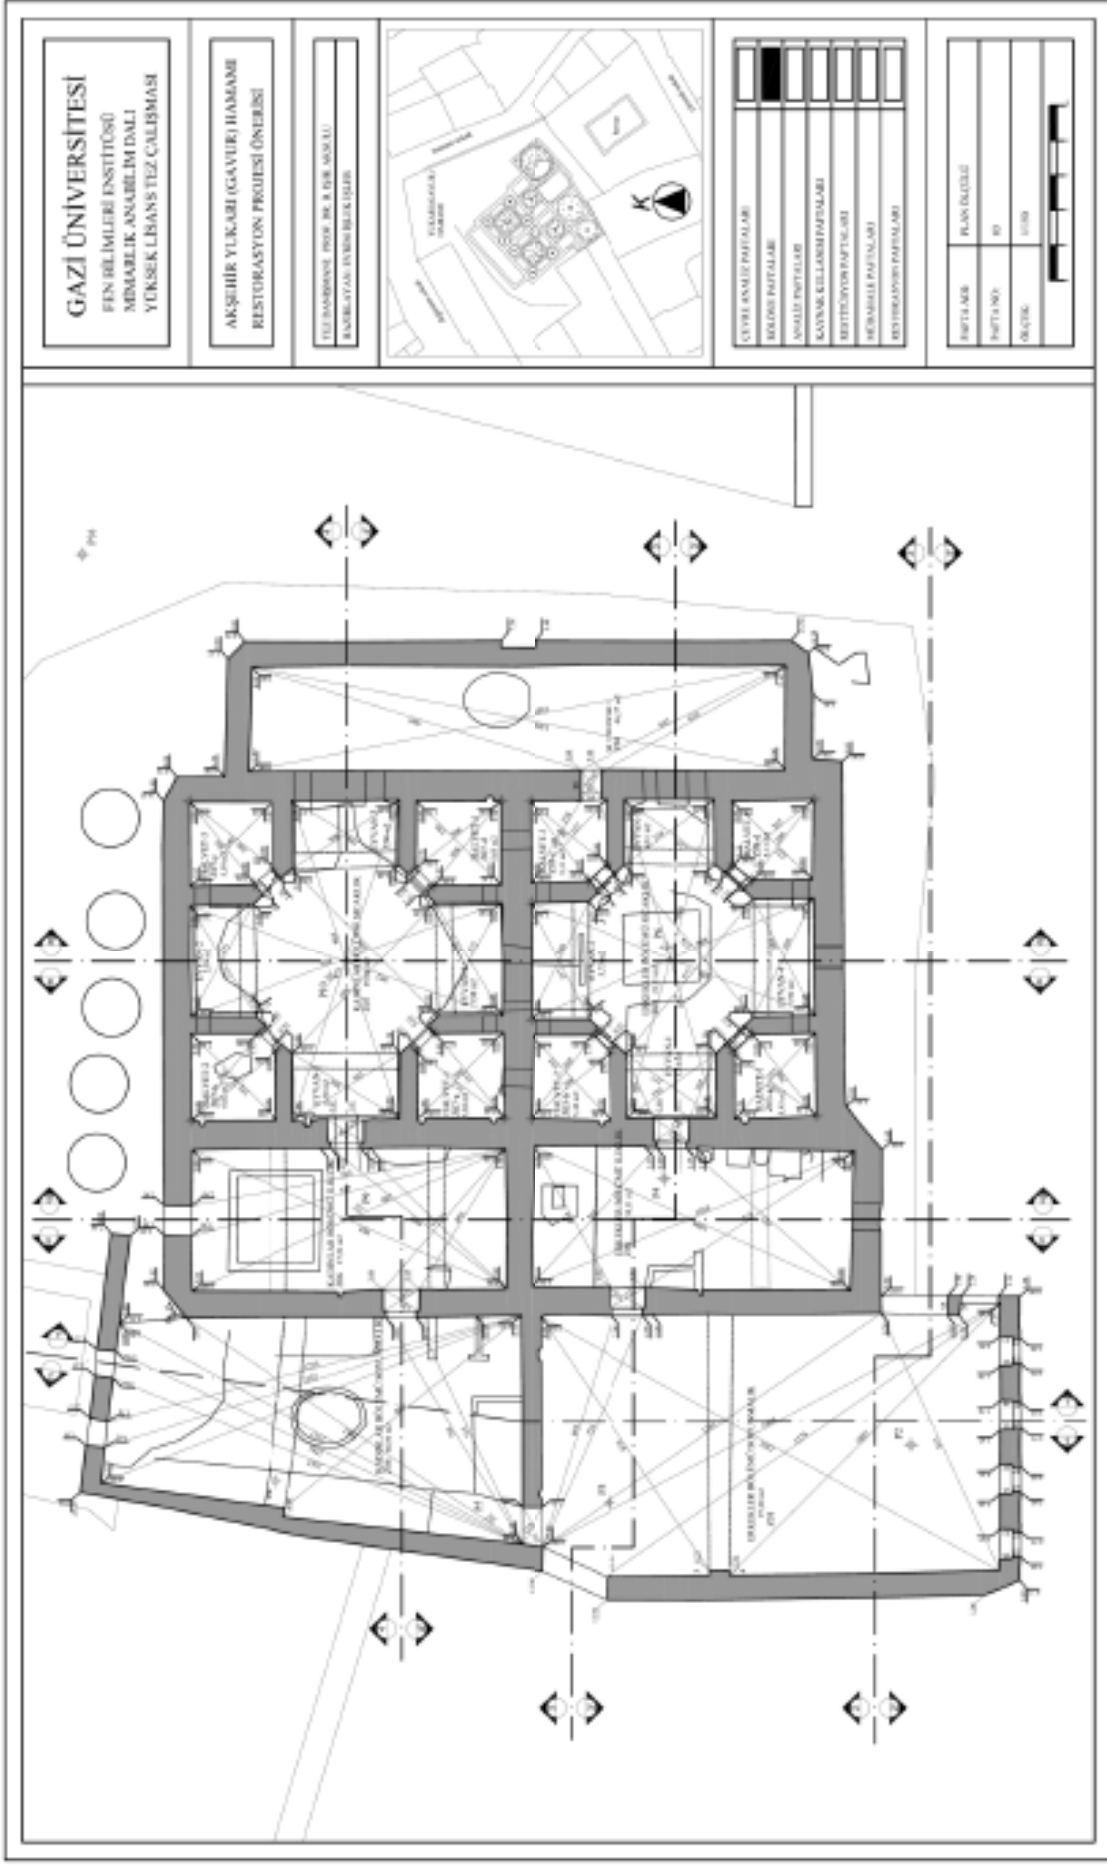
Yukarı (Gavur) Hamam vaziyet planı
